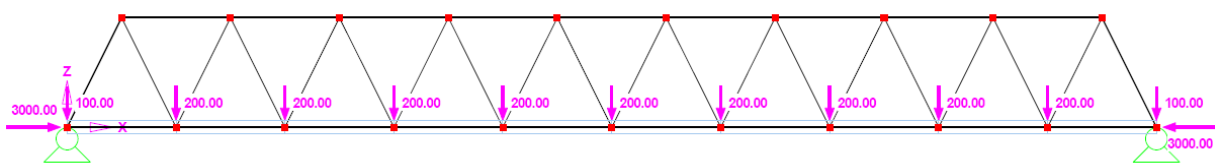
Variante 1 – generierte Stabstruktur
